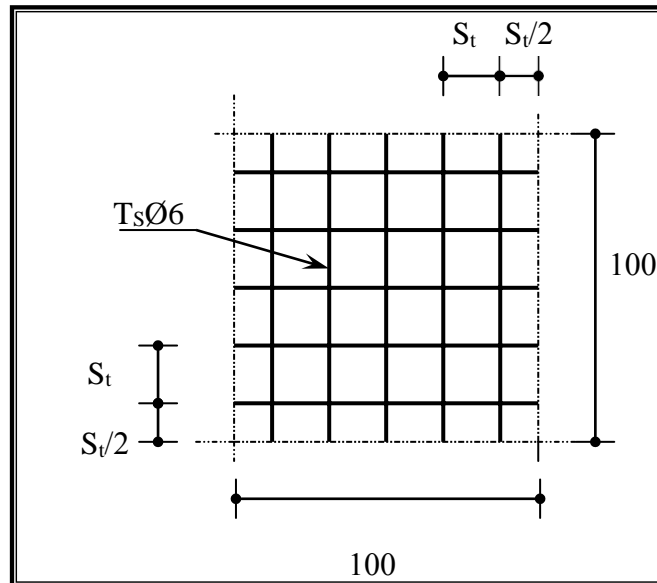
Disposition constructive des armatures de la dalle de compression
